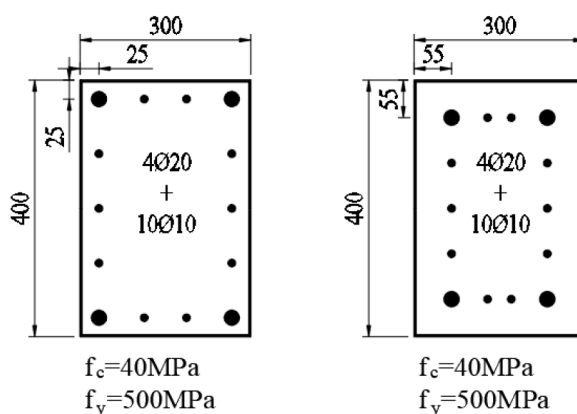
Secciones transversales: recubrimiento de hormigón
